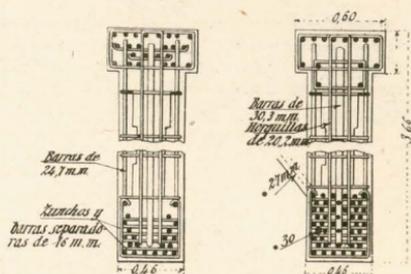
bis.—Armaduras de las vigas por A y B de fig. 25.
